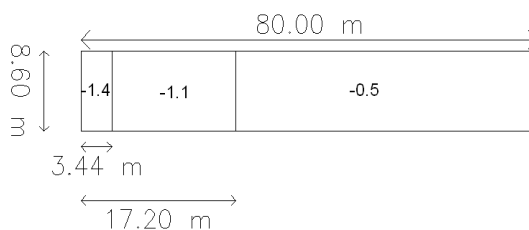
Disposição dos coeficientes de pressão exterior para as fachadas Norte e Sul.
